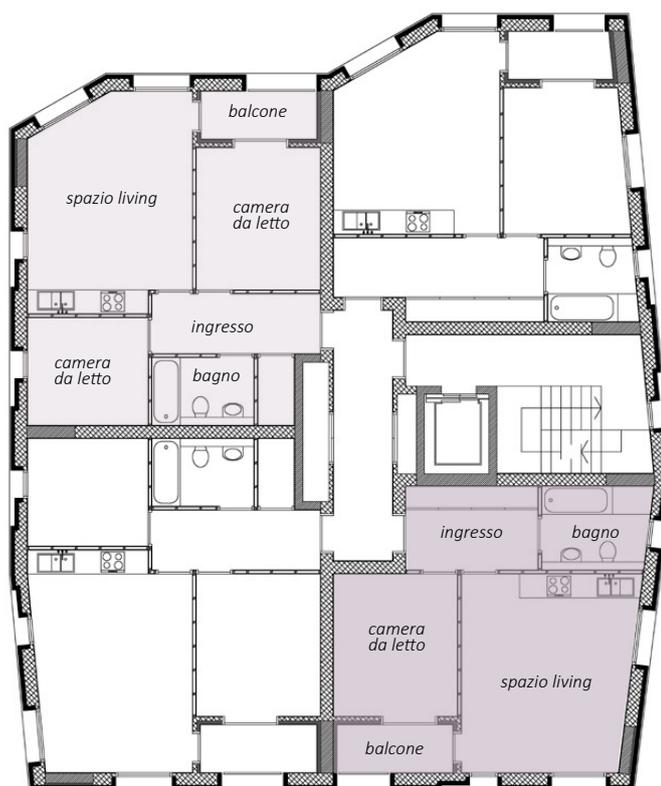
Sergison Bates architects, planimetria edificio, Londra.
